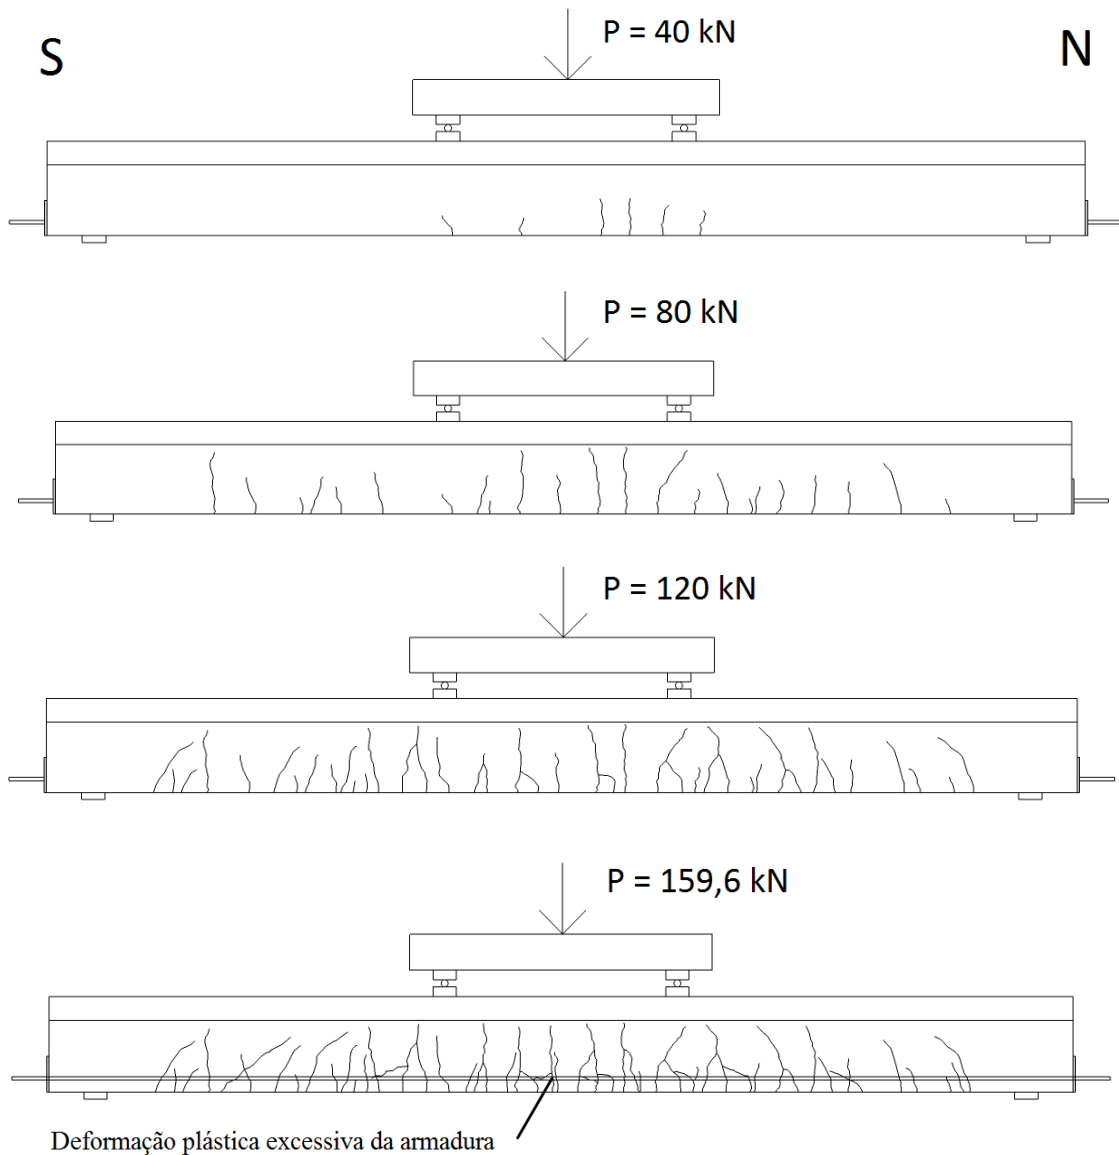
Evolução da fissuração na viga VR1 - RF
